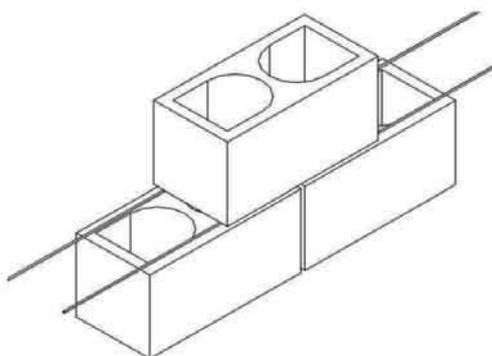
Barras corrugadas en tendeles en lugar de armaduras prefabricadas para tendel.
